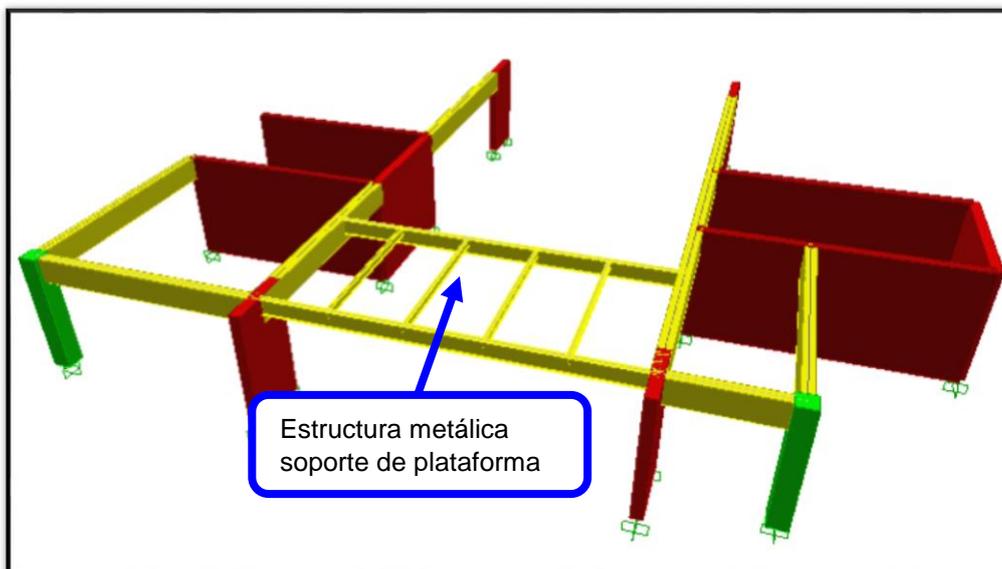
Vista 3D estructura metálica de la plataforma de piso
